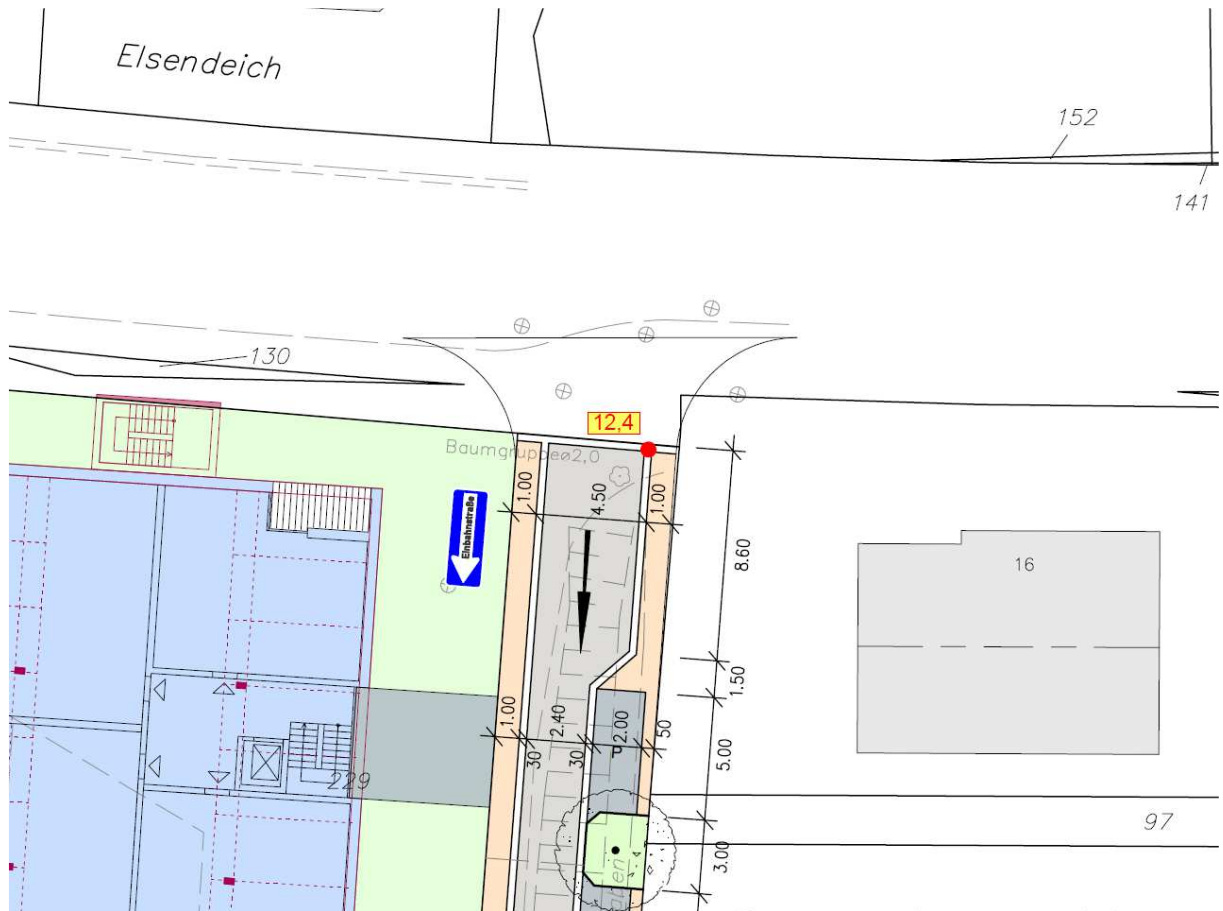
Ausschnitt Vorplanung - Konzept Straßenbau Waldstraßen-Quartier
